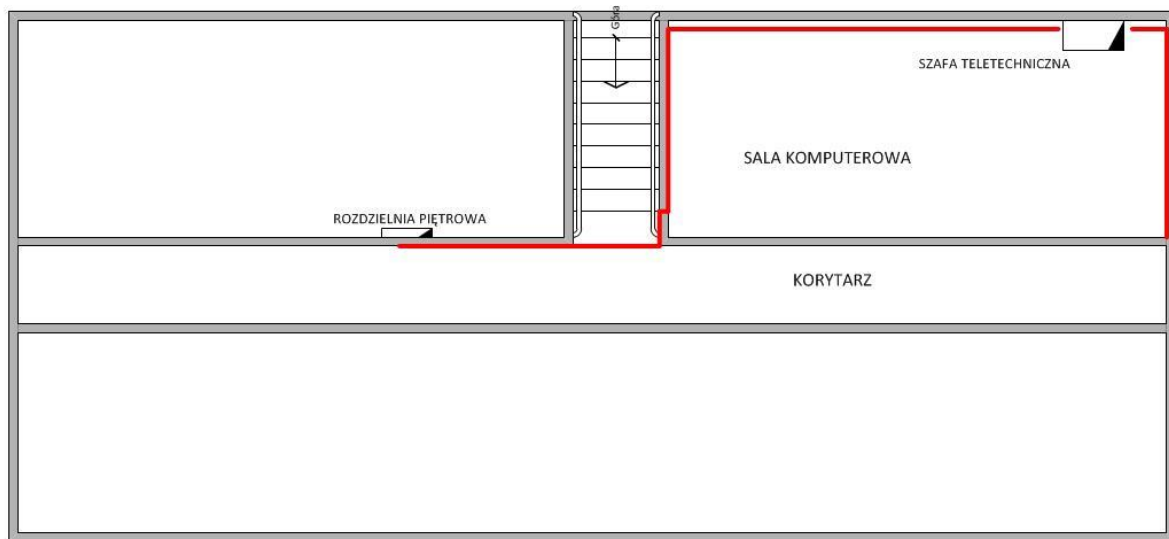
Szkoła Podstawowa w Nietkowicach– schemat instalacji teletechnicznych
